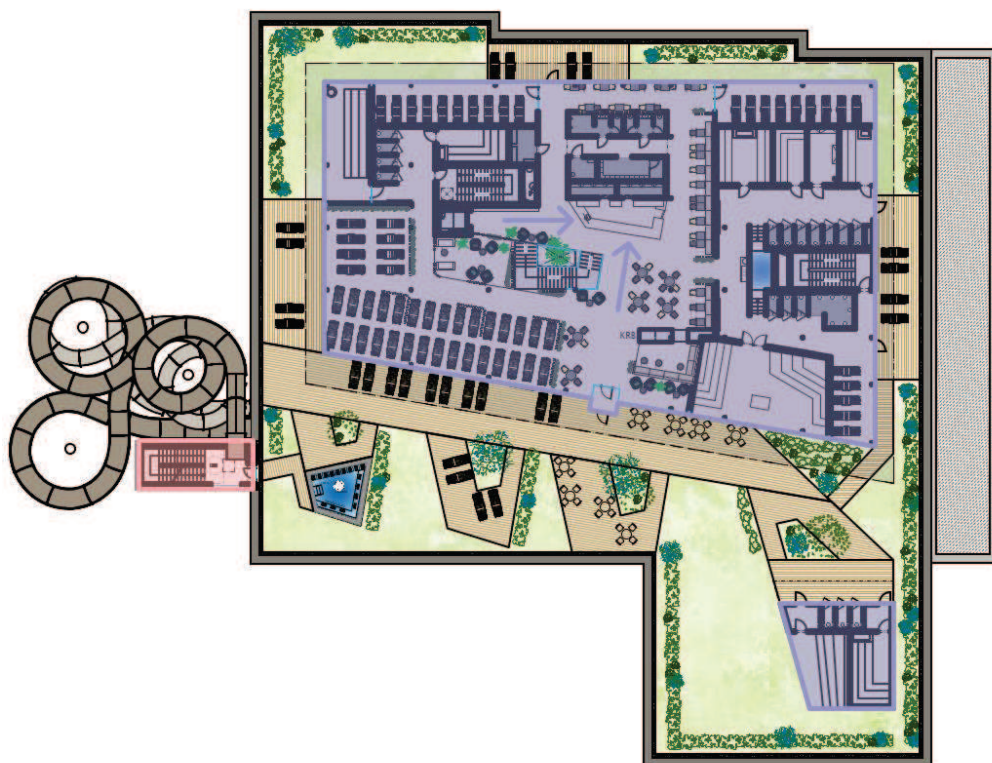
Situace areálu (zdroj: Architektonická studie 1/2025)
